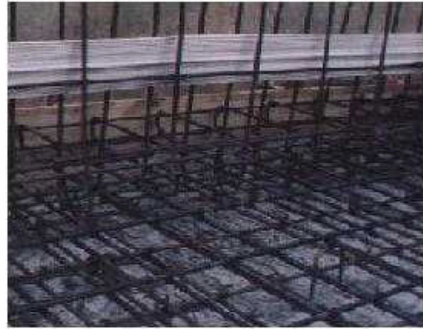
ARMADURA DE REFUERZO LOSA DE PISO
